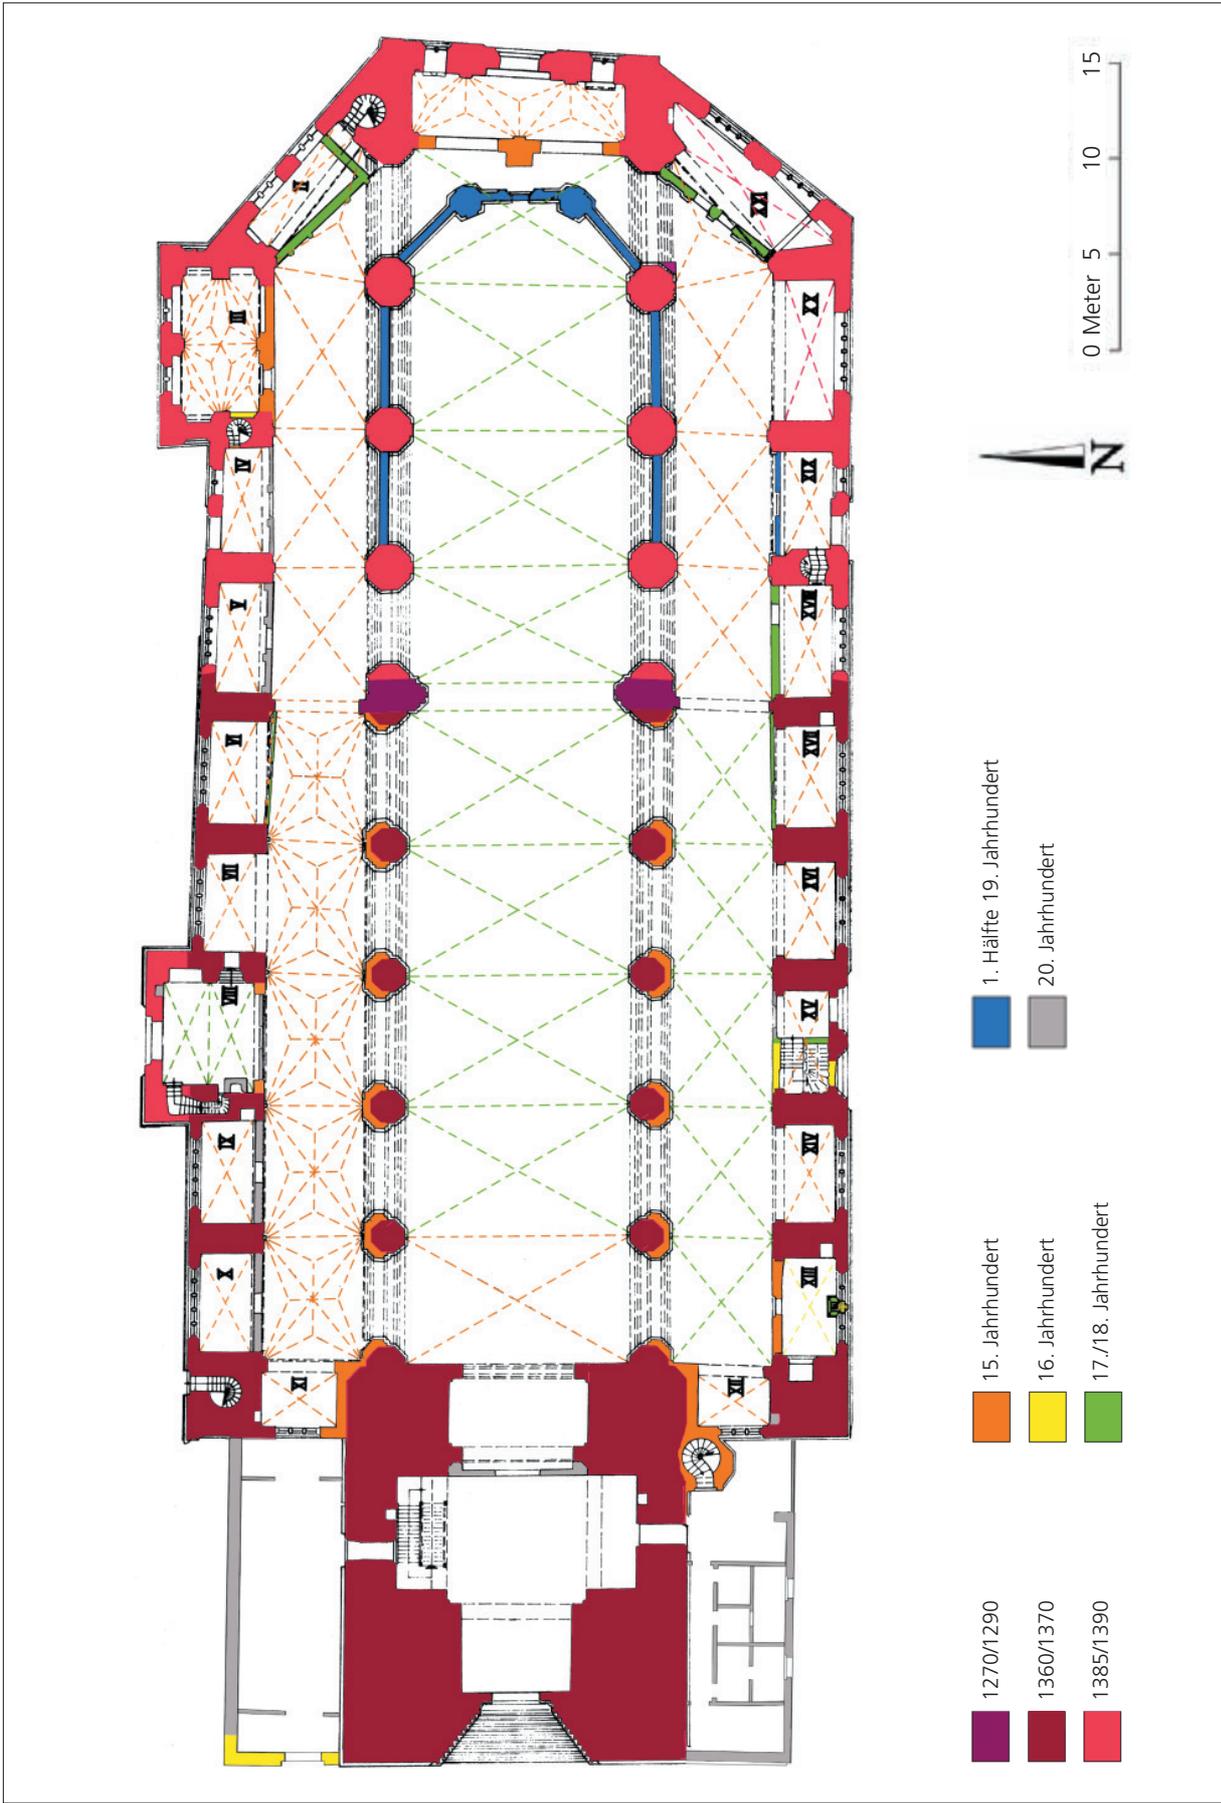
St. Nikolai, Grundriss mit der Kartierung der wichtigsten Bauphasen
